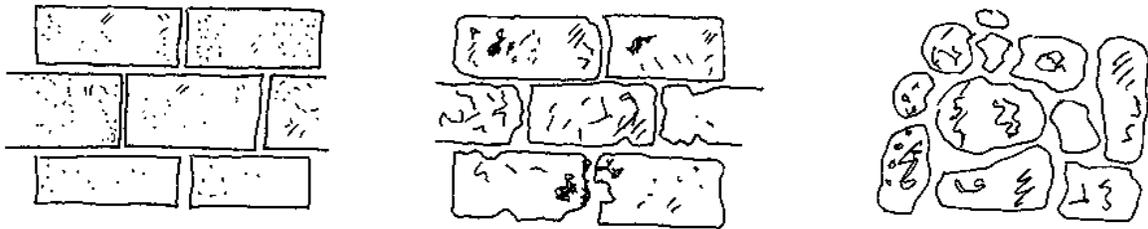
Ilustración de los principales acomodos de piedra: sillería, sillarejo y mampostería, <http://www.bluebagages.com/construccion/construccion-en-piedra.php>, 05 de Agosto de 2012.
